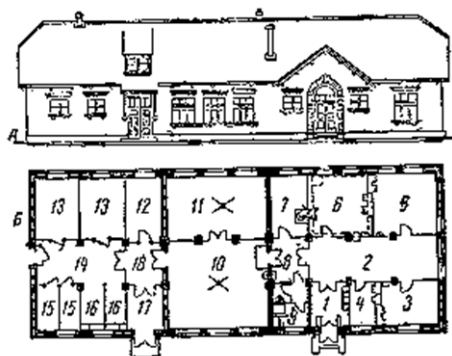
Типовой проект районной ветеринарной лечебницы № 0730: А – фасад здания амбулатории со стационаром, Б – план здания: 1 – тамбур; 2 – ожидальня; 3 – кабинет врача; 4 – кладовая; 5 – диагностический кабинет; 6 – аптека; 7 – кубовая; 8 – шлюз; 9 – санузел; 10 – манеж; 11 – операционная; 12 – помещение для фуража и подстилки; 13 – денники; 14 – проход; 15 – станки; 16 – стойла; 17 – тамбур; 18 – шлюз.
